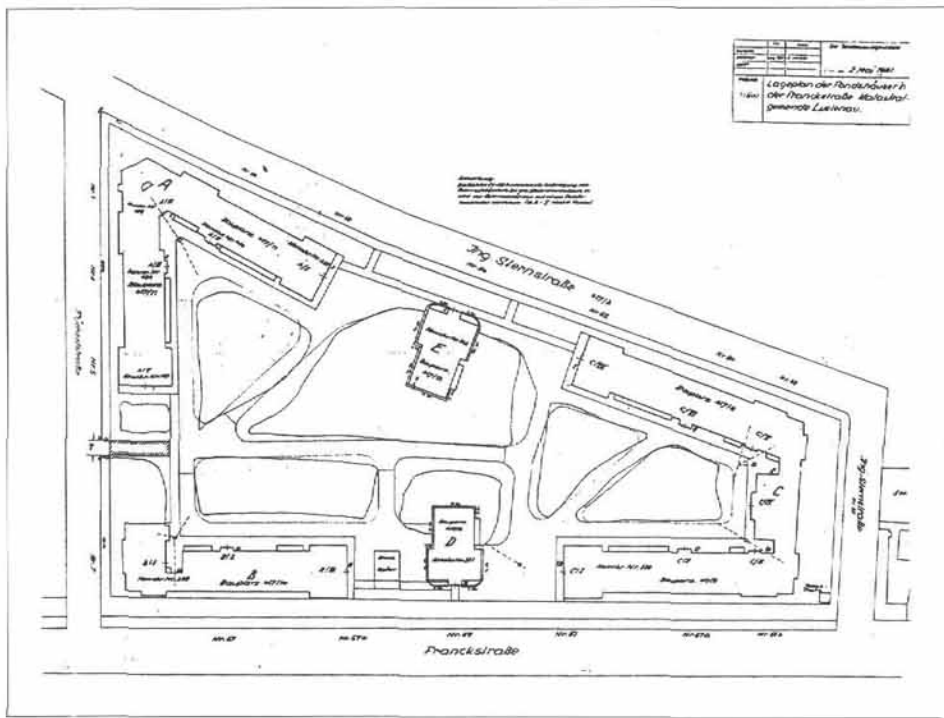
Staatsbahnwerkstätten, Lageplan der Siedlung (AStL).
